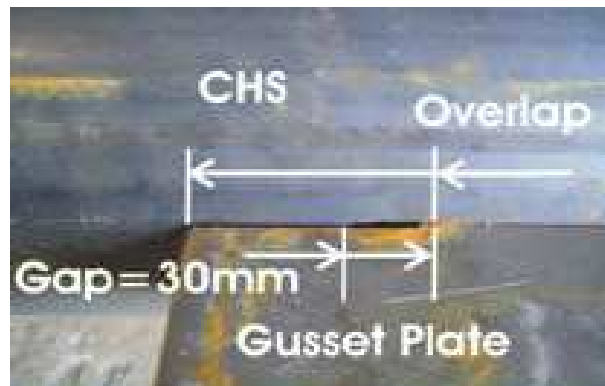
Raso simultâneo no tubo e na chapa, pormenor de assemblagem antes de soldadura. (Fonte: (AISC, 2012))
